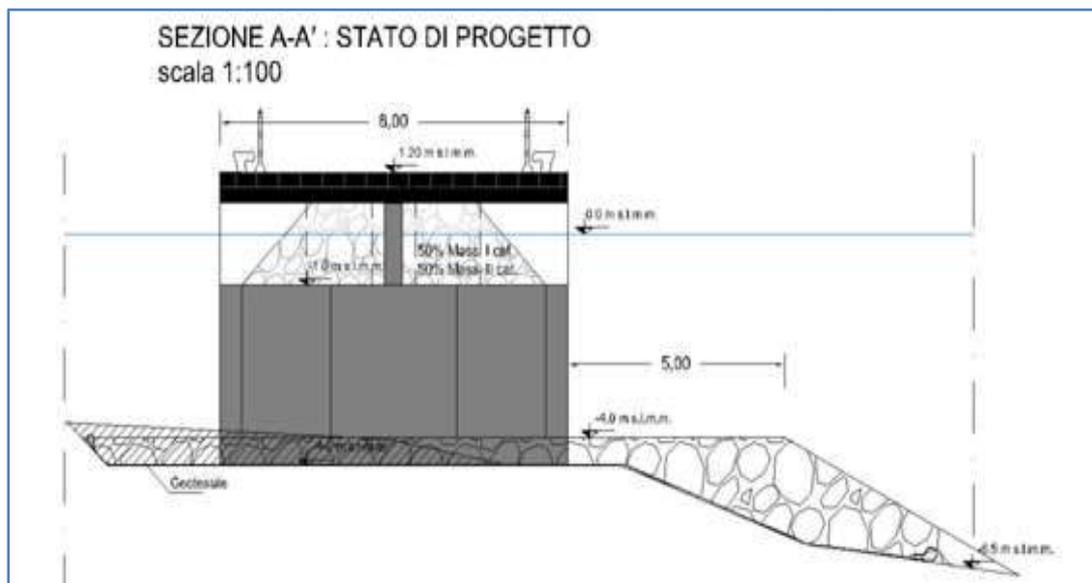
Fondazione con piano di posa a -4.0 m s.l.m.m.
